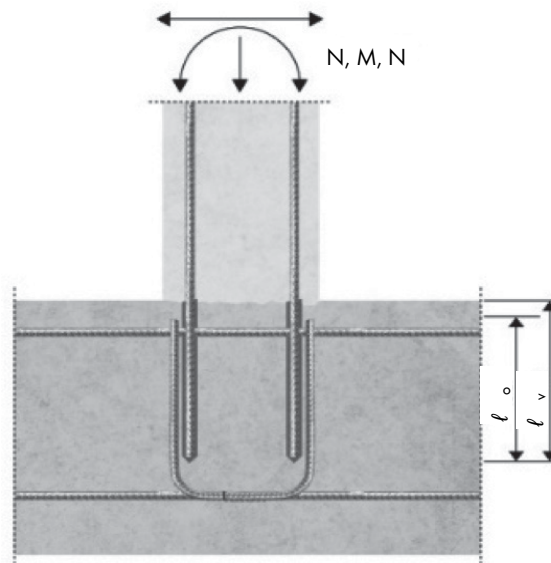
Соединение внапуск в фундаменте колонны или стены, где арматурные стержни находятся под нагрузкой на вырыв
